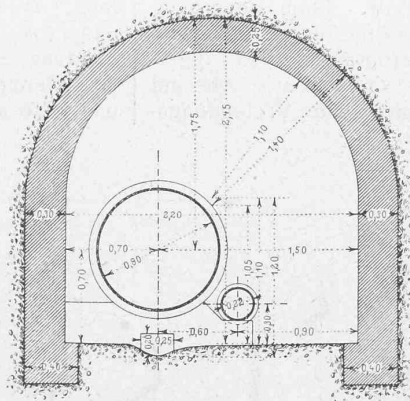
Querschnitte des Stollens für die Druck- und Trinkwasser-Leitungen. Masstab 1 : 50.
